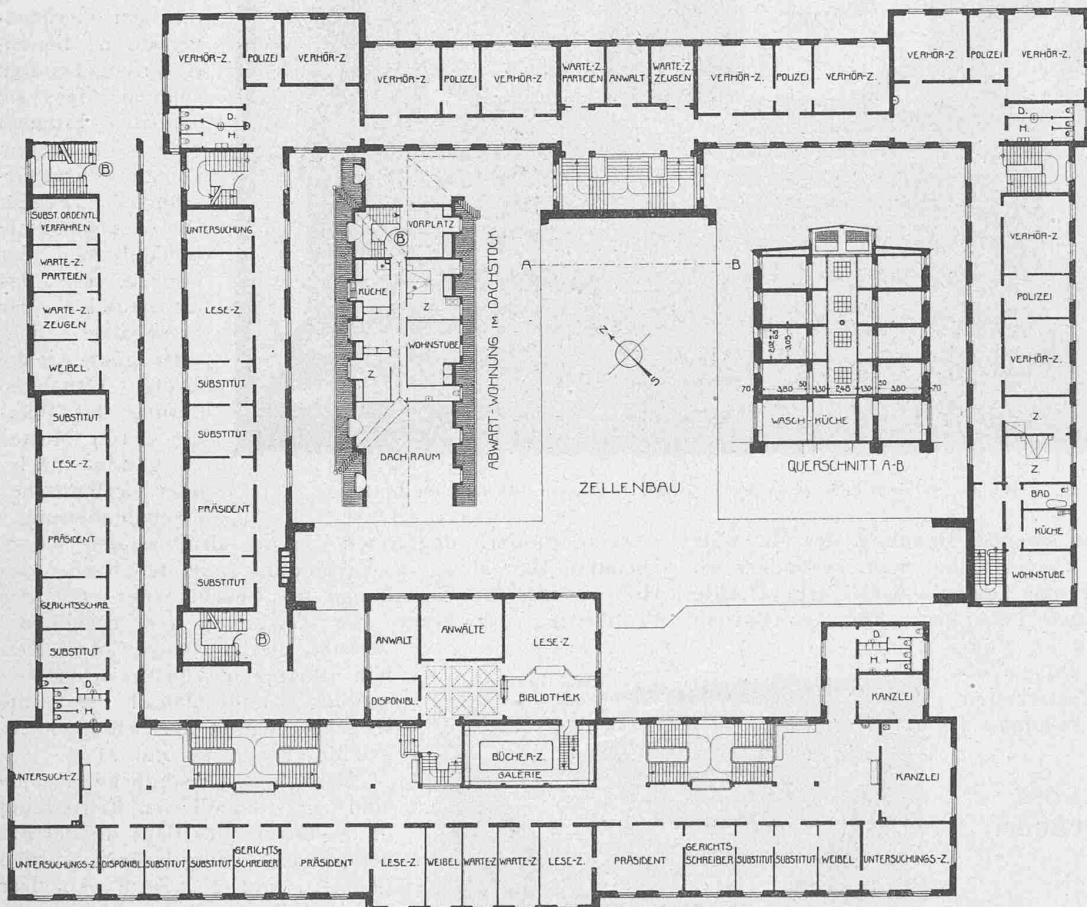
Grundriss vom II. Stock. — 1 : 600. (Die Grundrisse auf Abb. 11 und 12 sind ineinandergeschoben).
